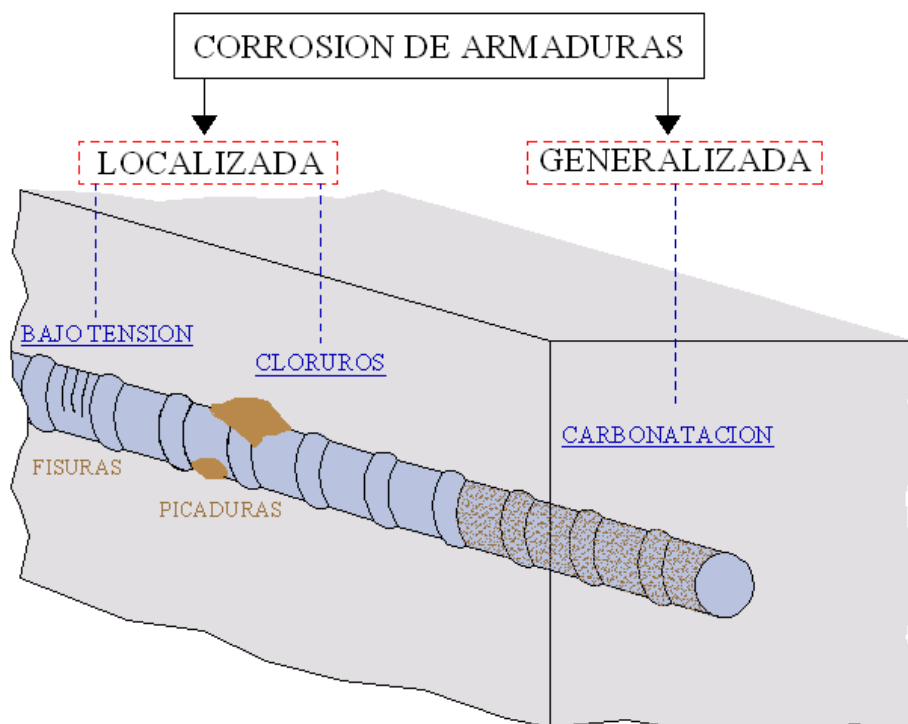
Tipos de corrosión de las armaduras [17]
